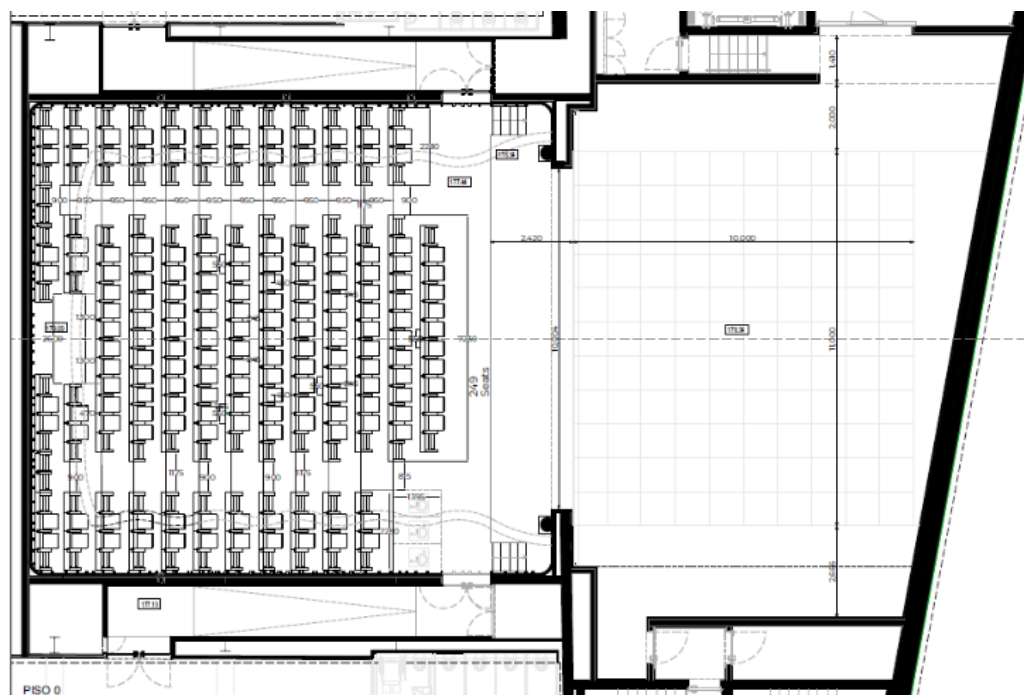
Planta Piso 0 (plateia) do Teatro Jordão. [36]
